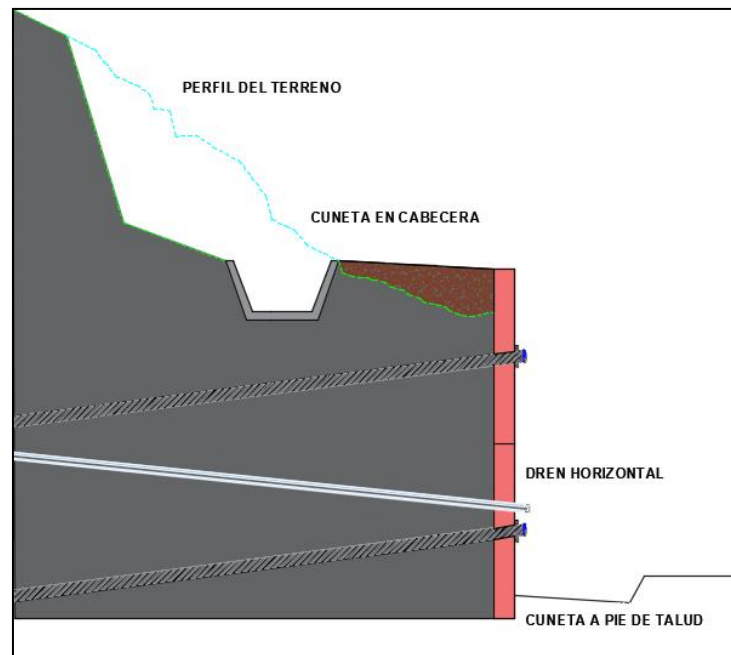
Esquema de la red de drenaje de una sección tipo. Fuente: Propia
